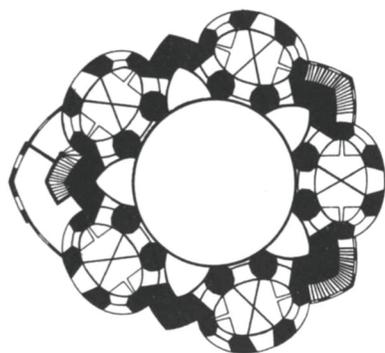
Grundriss eines Zentralbaus mit 5 Ellipsen. Saar/Mahren 1719-22
